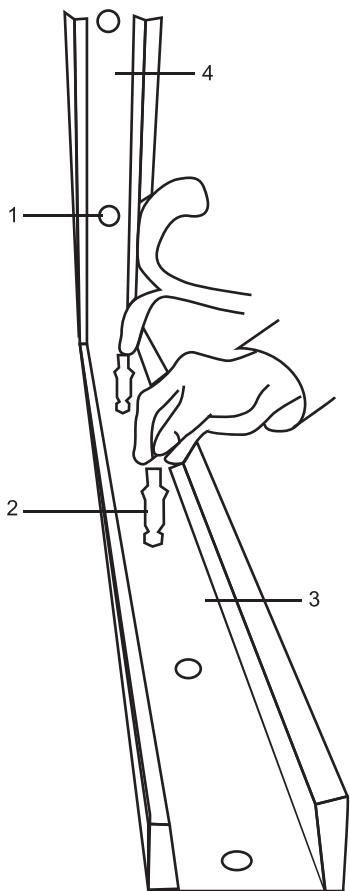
Крепление металлического каркаса перегородки к стене и полу распорными дюбелями:
